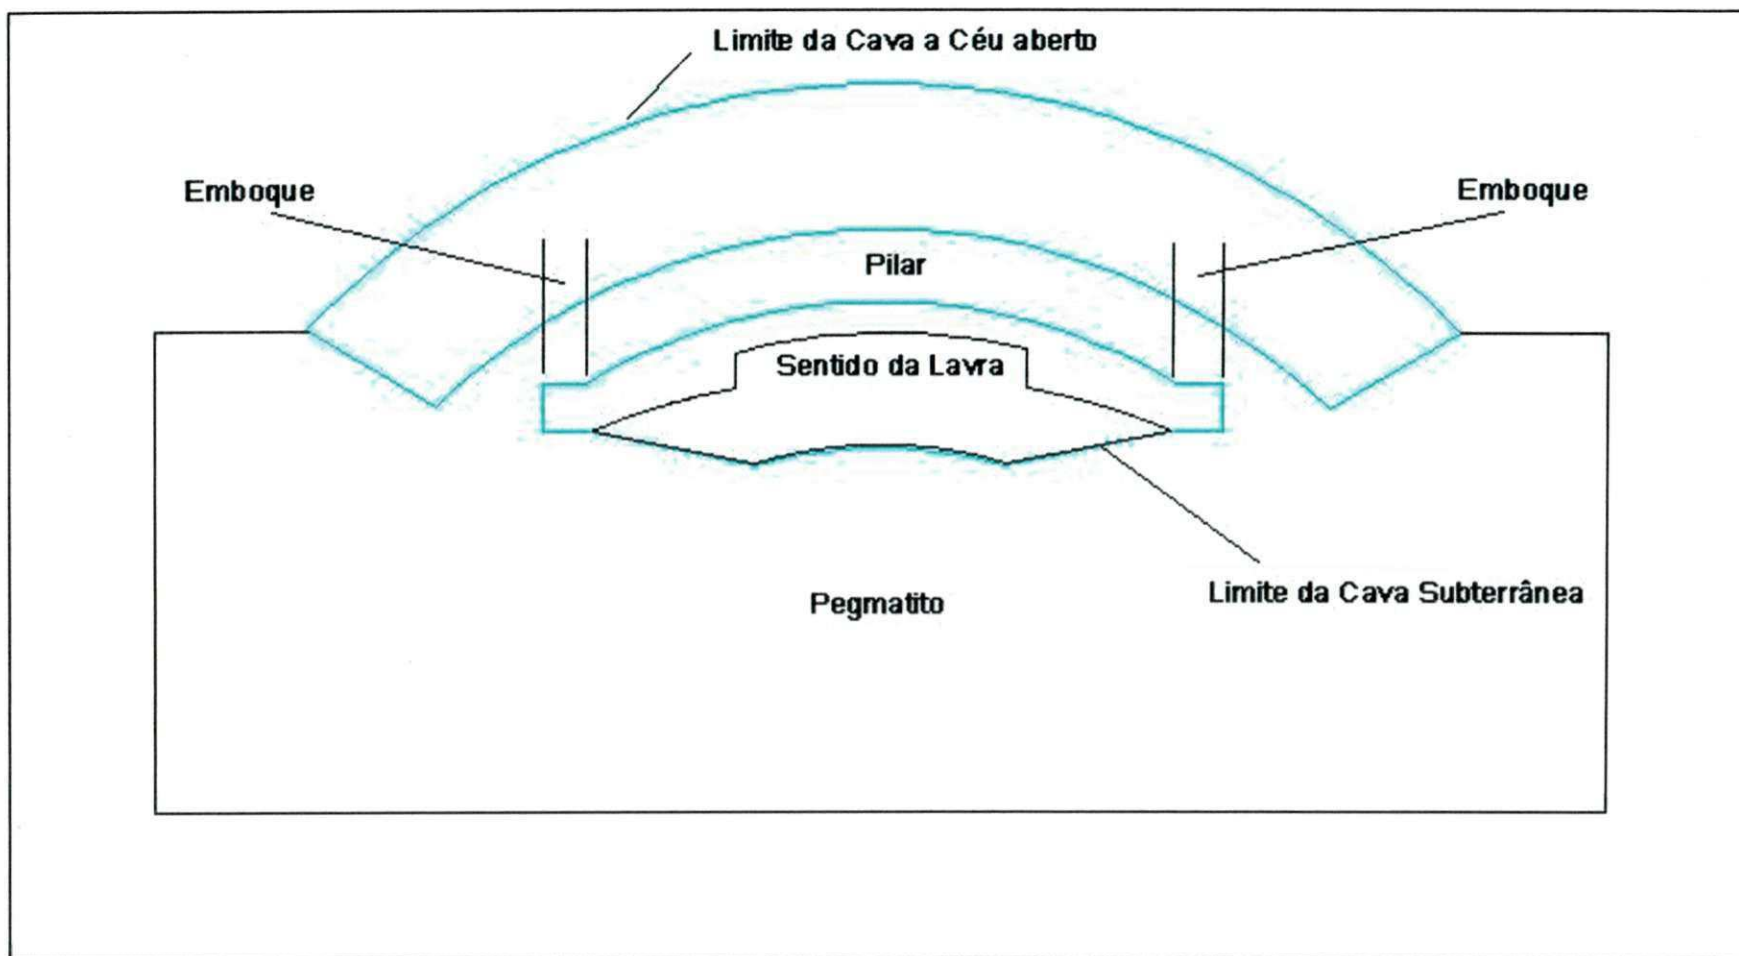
Perfil longitudinal esquemático com seqüência da lava subterrânea (modificado)
